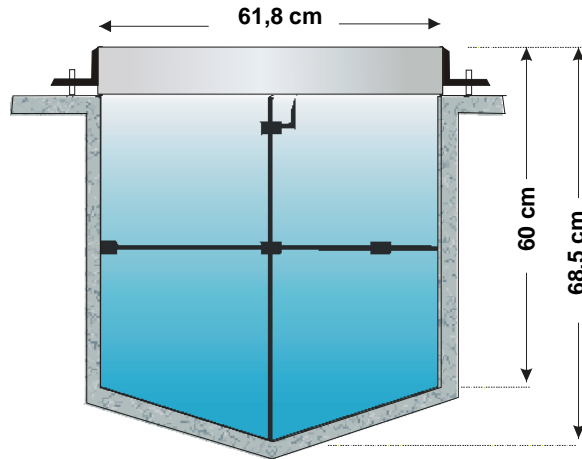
Tanque enterrado com 3000 cm<sup>2</sup> de superfície evaporante.
